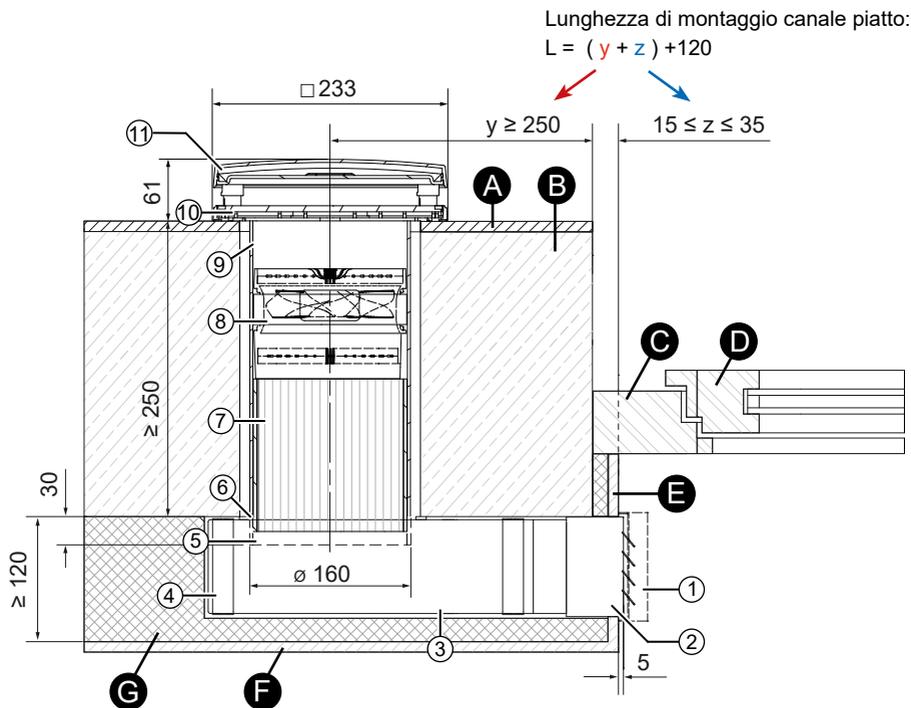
disegno in sezione del dispositivo iV-Smart+ Corner (vista dall' alto)
